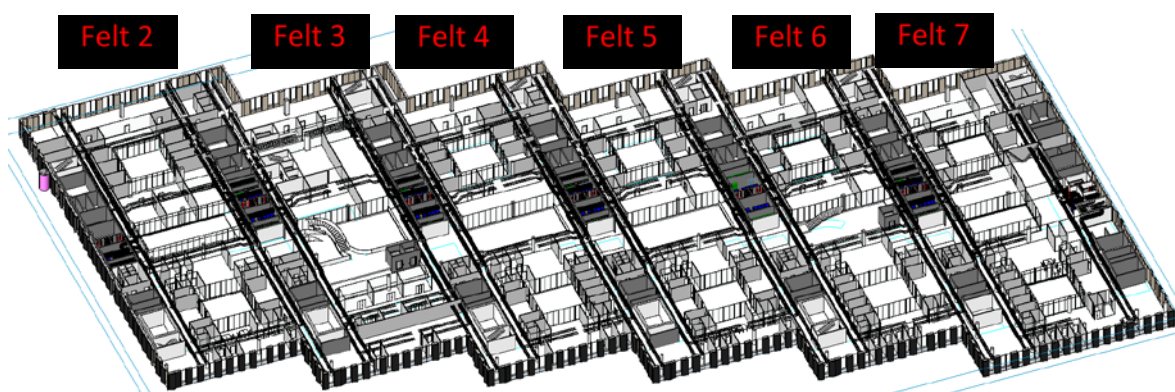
Fordelingszoner plan 8 tårn vest. Tilsvarende på plan 06 og 07 etg. tårn vest.
